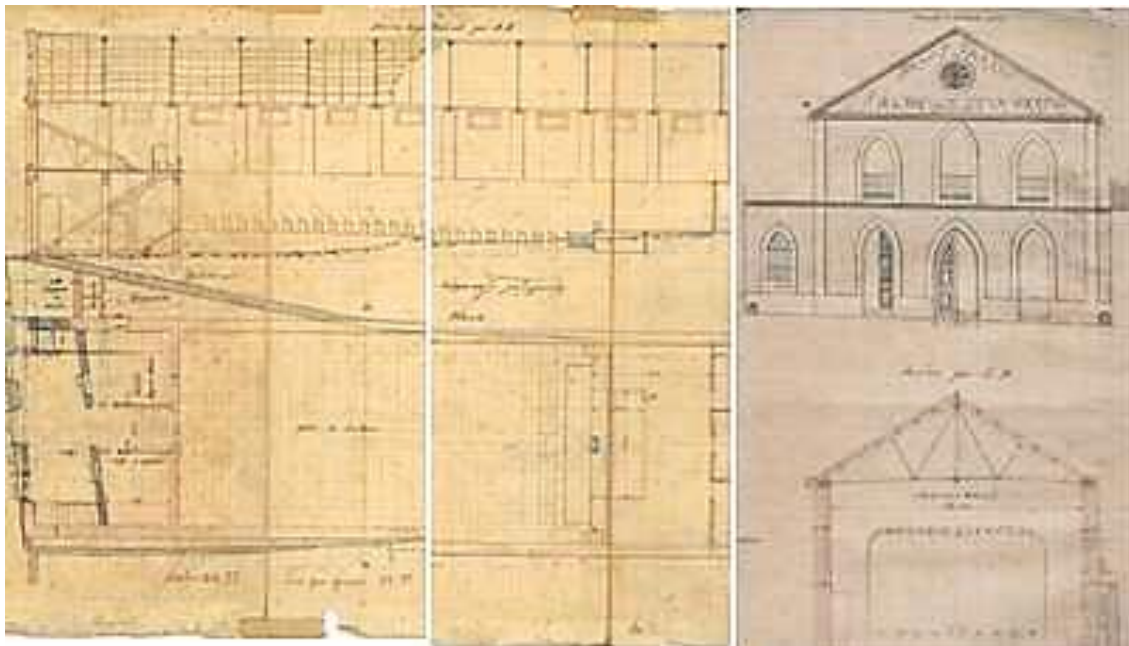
Planos del interior y de la fachada del Teatro Calderón de la Barca de Montijo (SÁNCHEZ GARCÍA, C., 1904).
